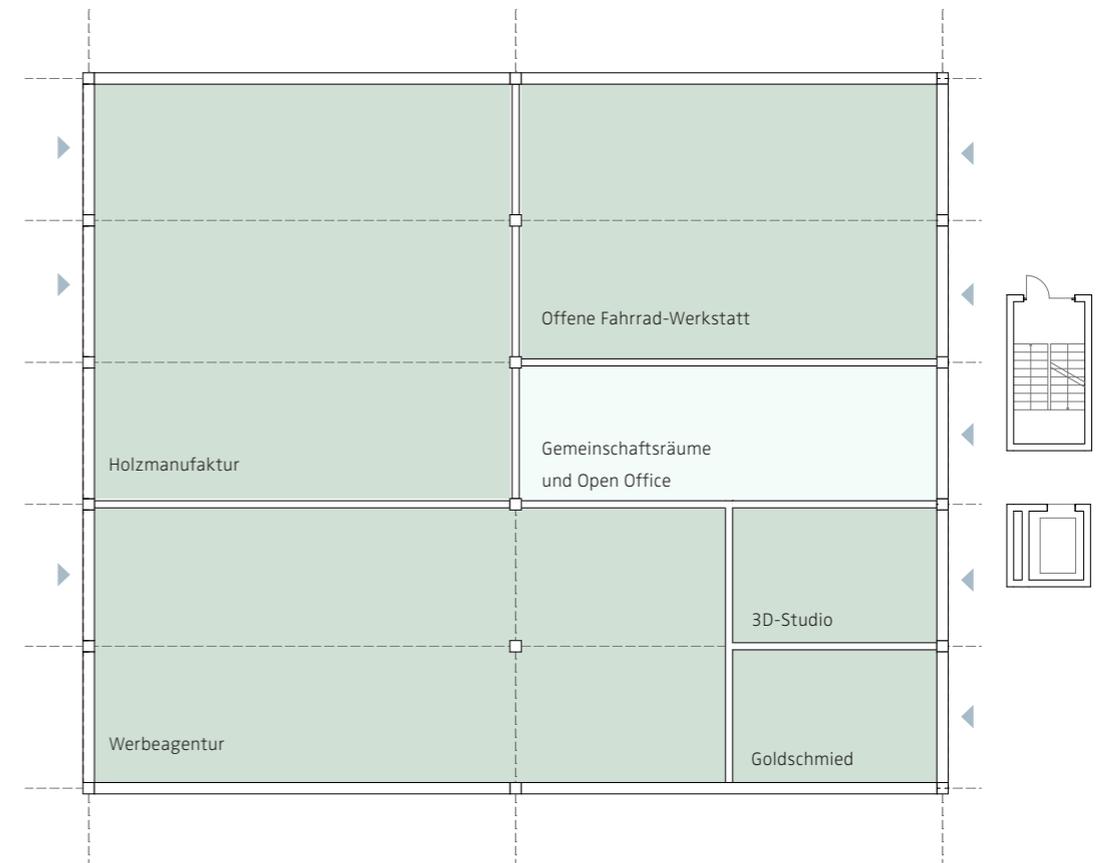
Schematischer Grundriss Gemischte Produktion
